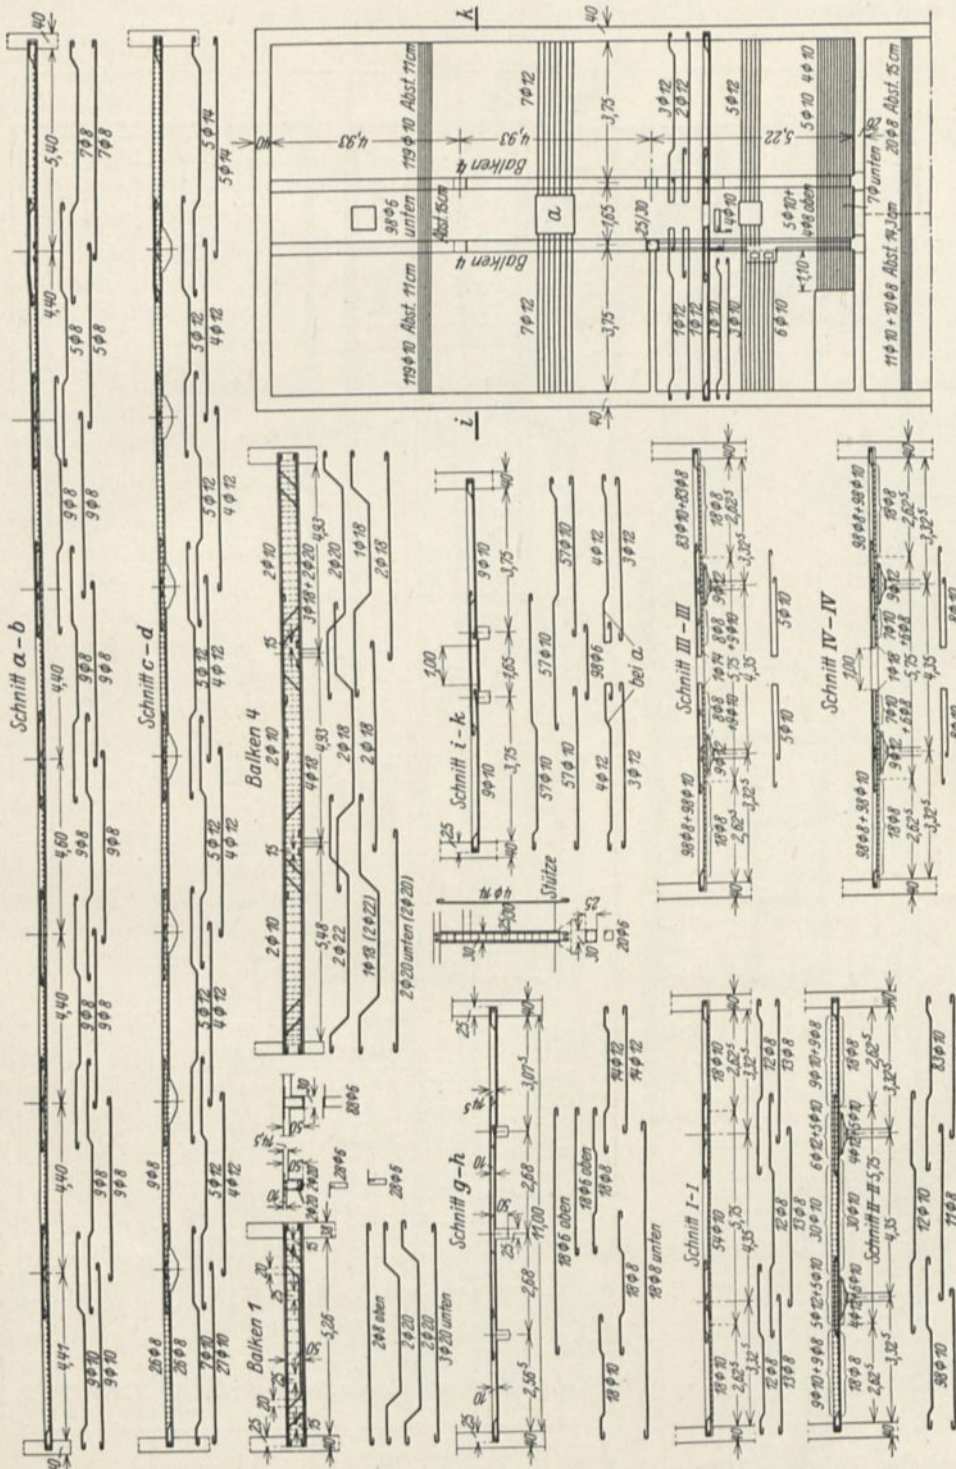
Stallgebäude Schloß Haag b. Geldern. Bewehrung der Staldecke samt Einzelheiten.
